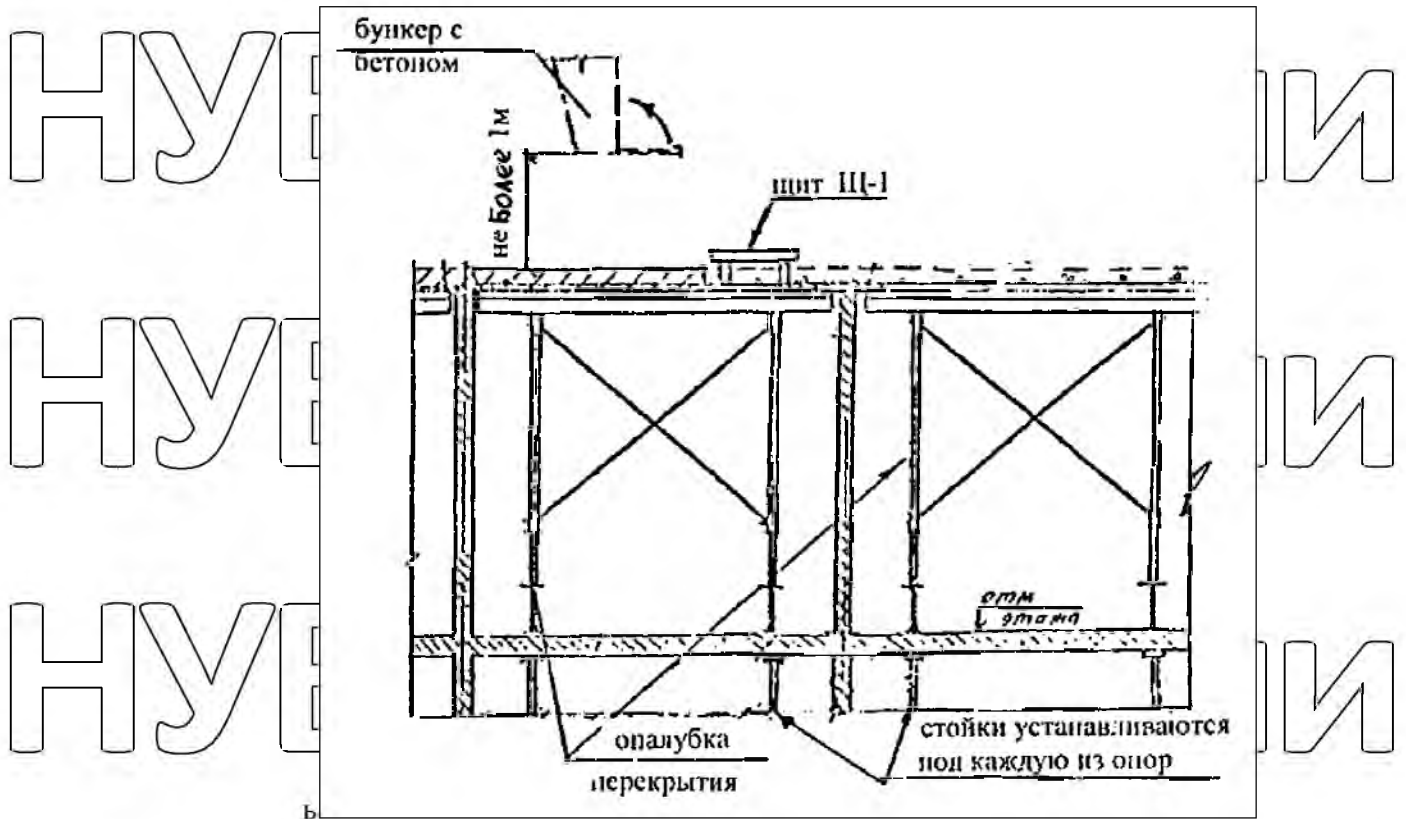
Вивантаження бетонної суміші з бункера в опалубку
